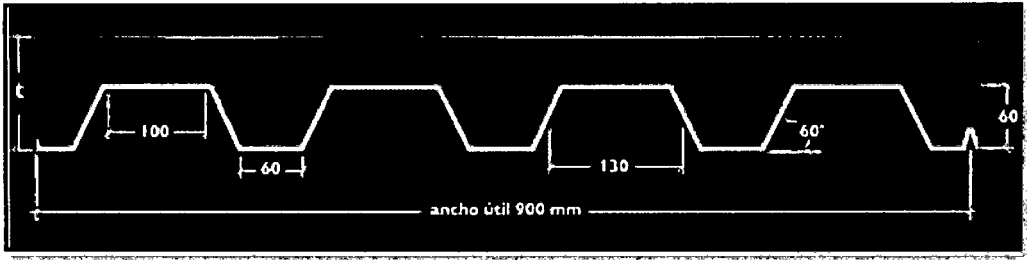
1: Detalle del perfil AD-600 (Acero Deck, 2013).
